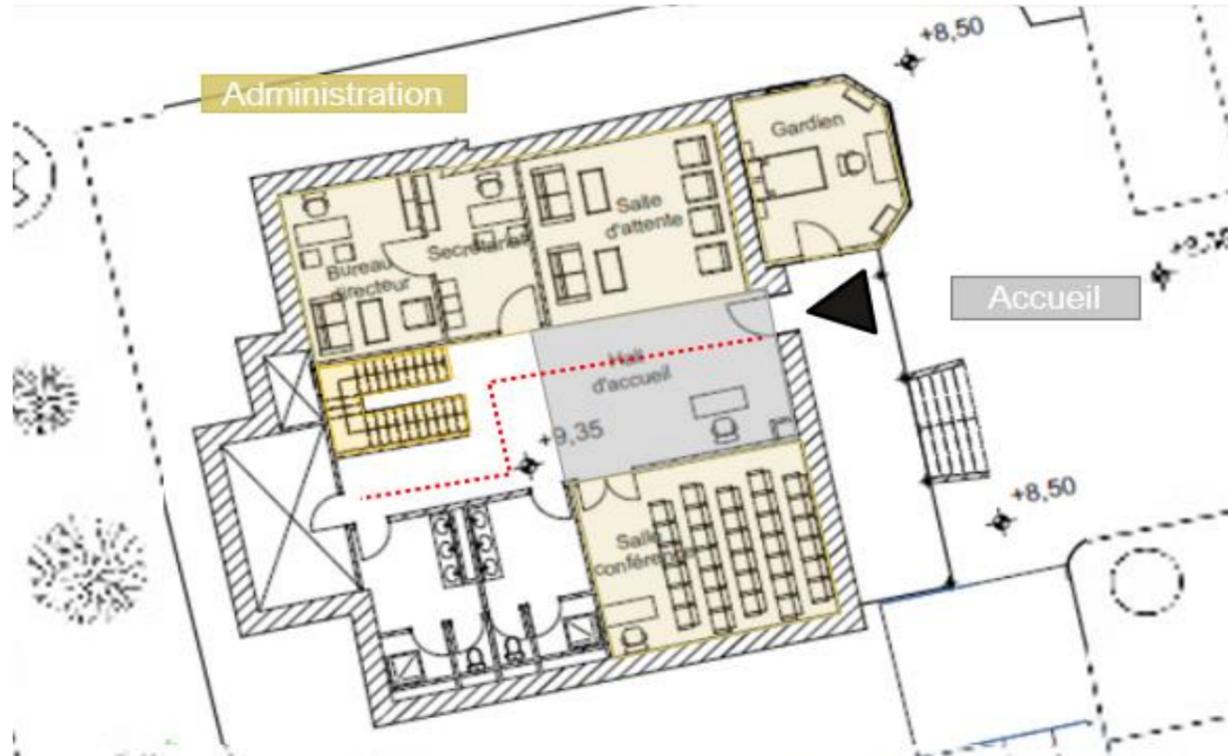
Plan de rez-de-chaussée – Bloc Administratif
